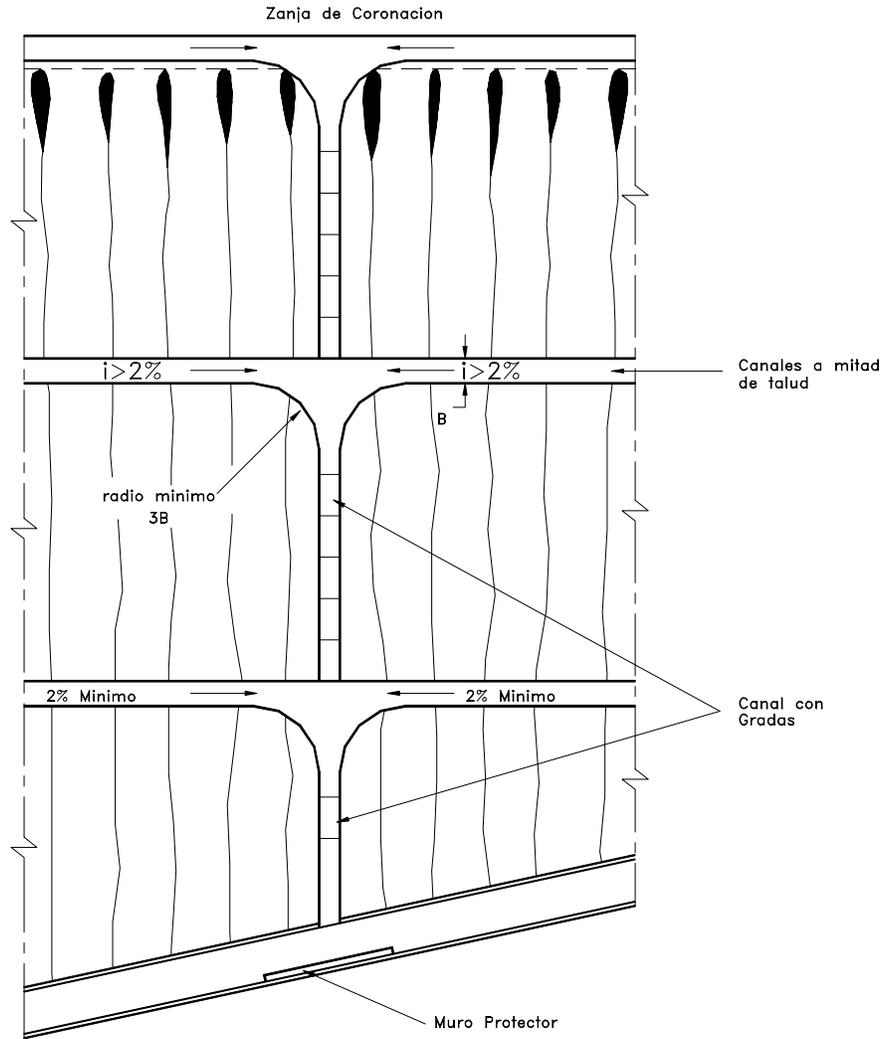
Esquema de entrega de canales interceptores a mitad de talud.
